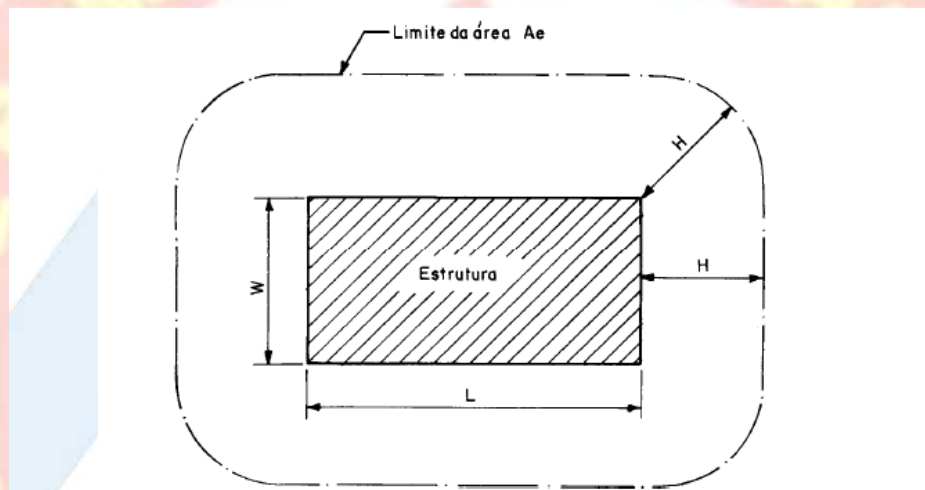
Delimitação da área de exposição equivalente (Ae) - Estrutura vista de planta
